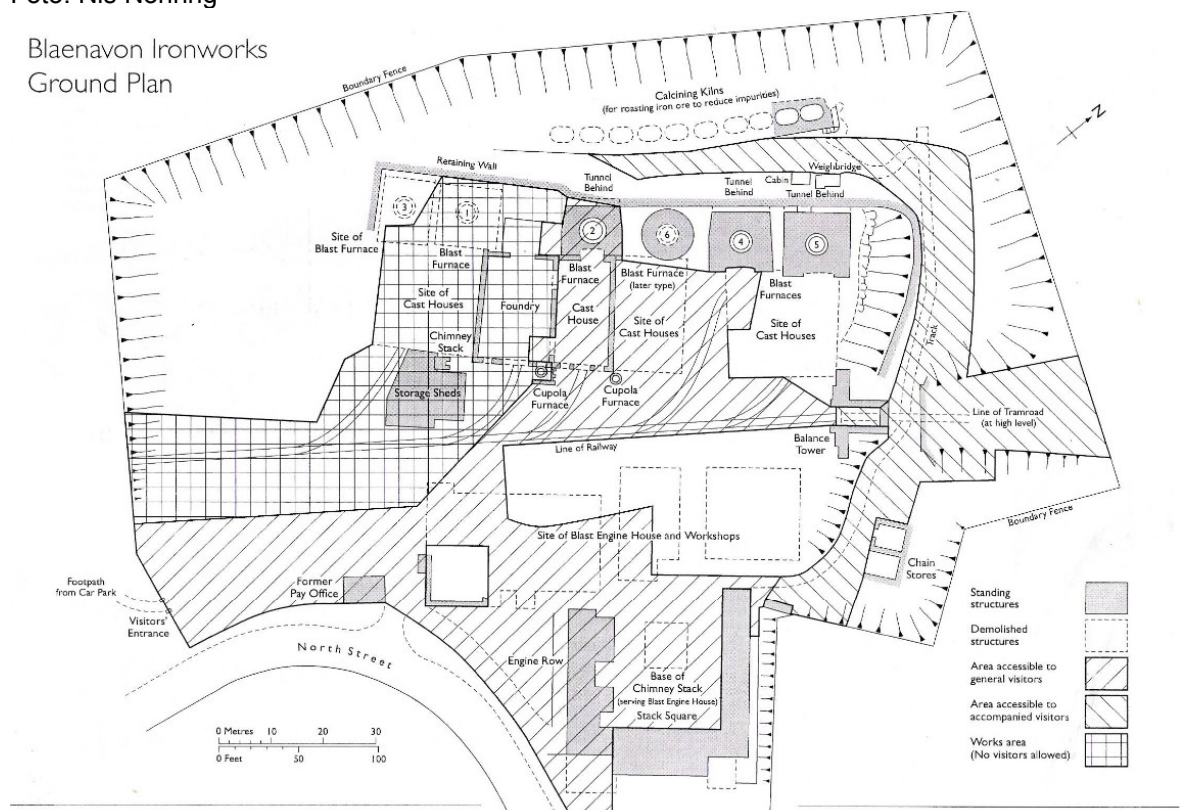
Blaenavon Ironworks Lageplan
